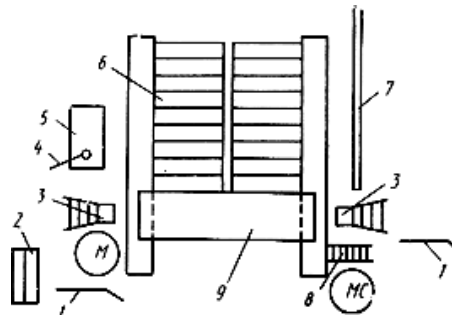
Схема организации рабочего места при монтаже лестничных площадок и лестничных маршей
